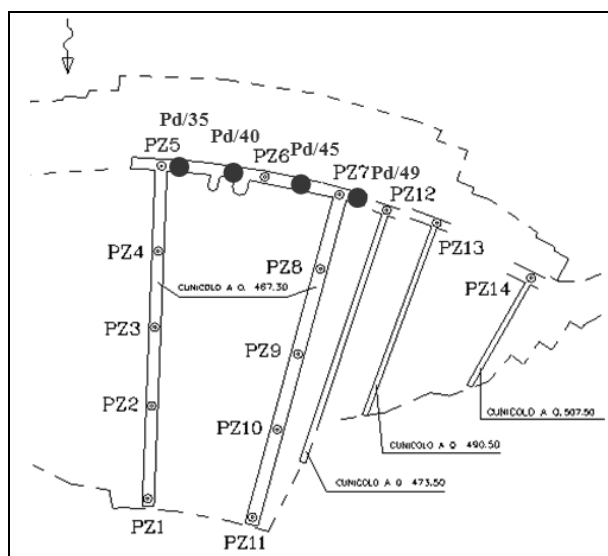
Pianta con ubicazione dei piezometri originali e di quelli recentemente realizzati in fondazione dalla galleria di raccolta ed ispezione
